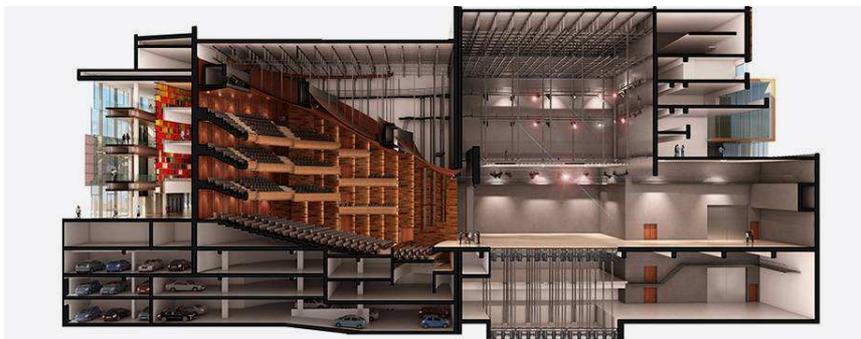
Sección longitudinal y vista general con el proyecto completo
